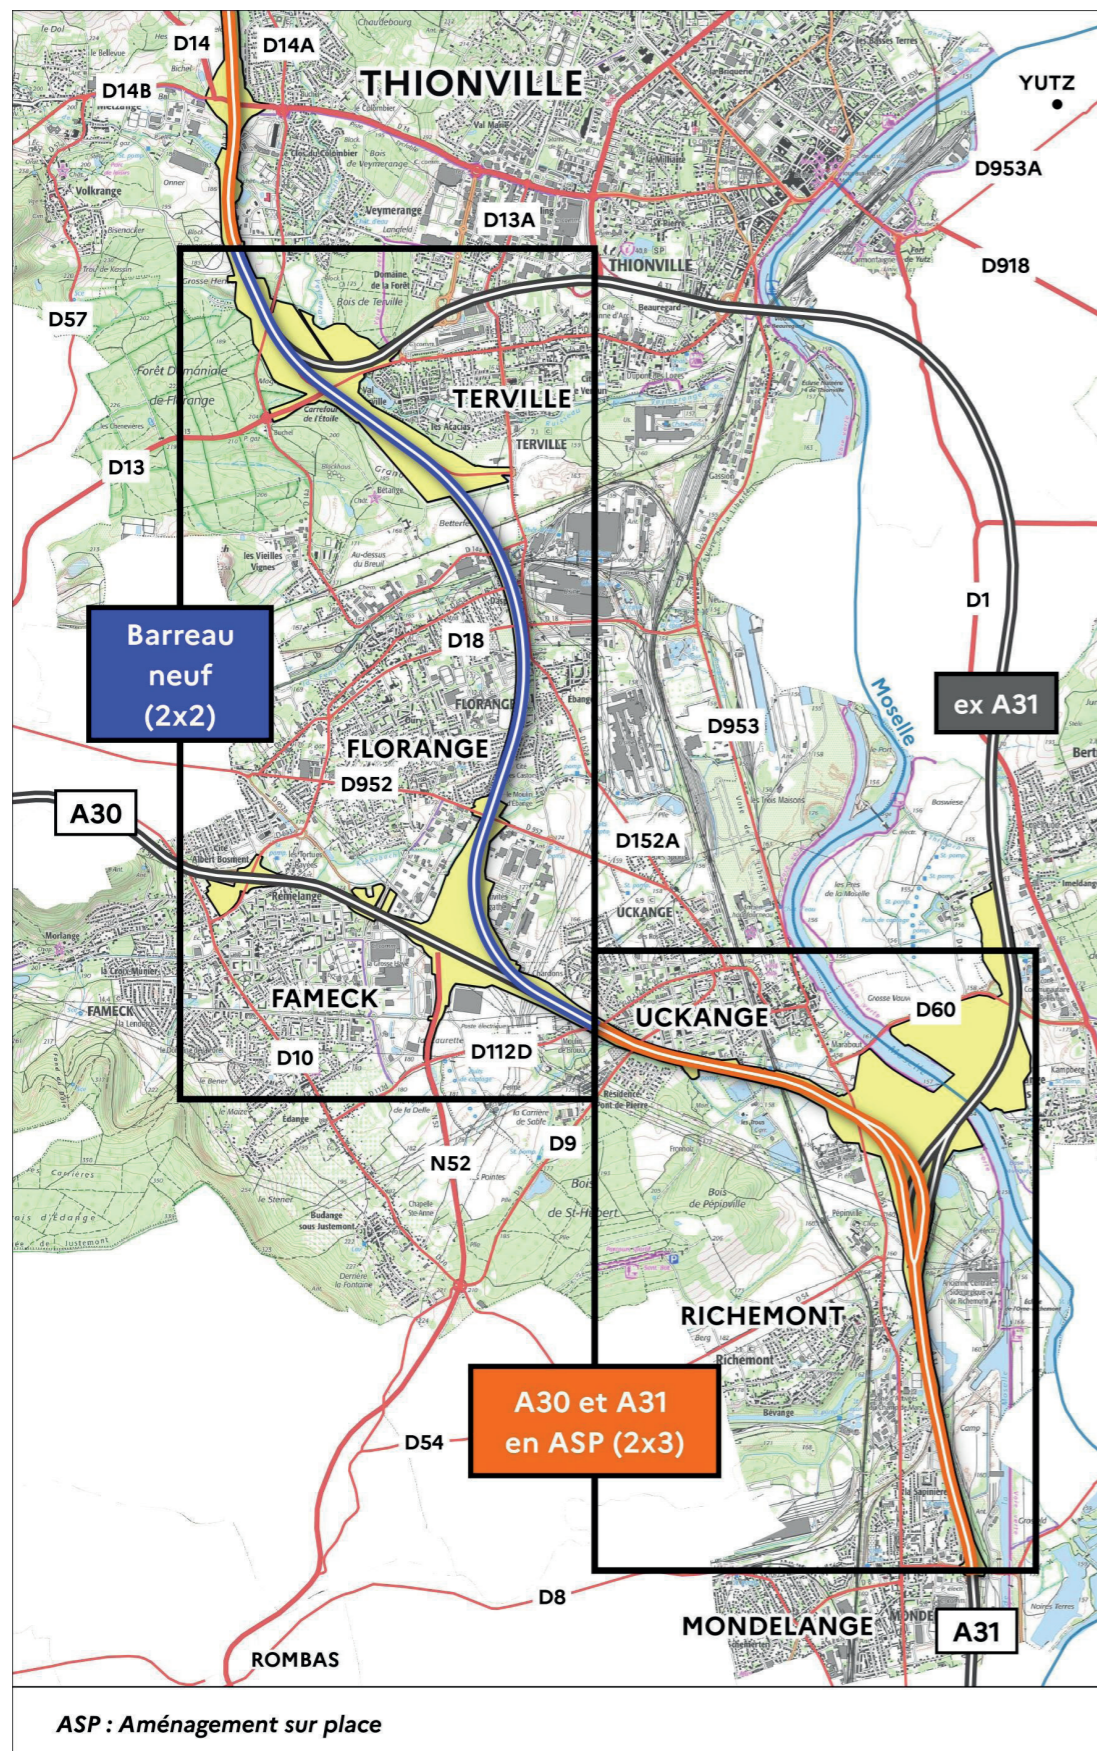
Barreau neuf et section de l'A30 et A31 en aménagements sur place
